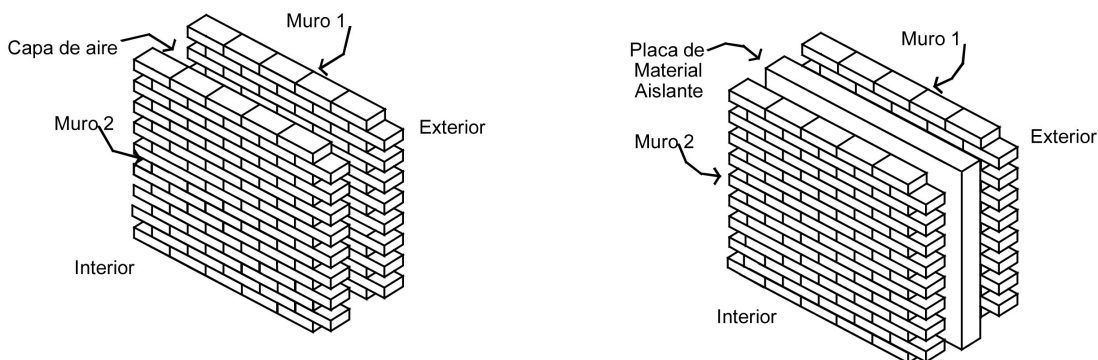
Ejemplos de muro doble con capa de aire y placa de aislante entre los dos muros.
